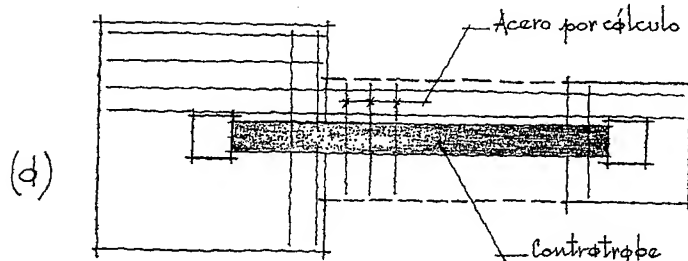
Unión de dos zapatas aisladas. Planta, (d).
